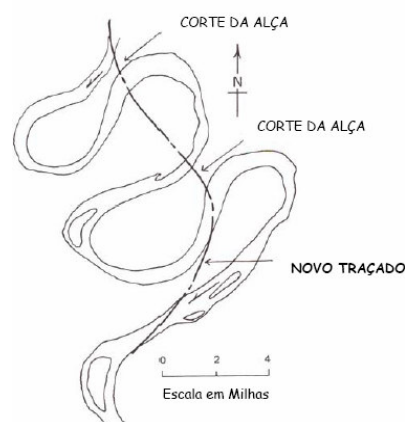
Retificação do trecho meandrante do rio – *novo traçado
